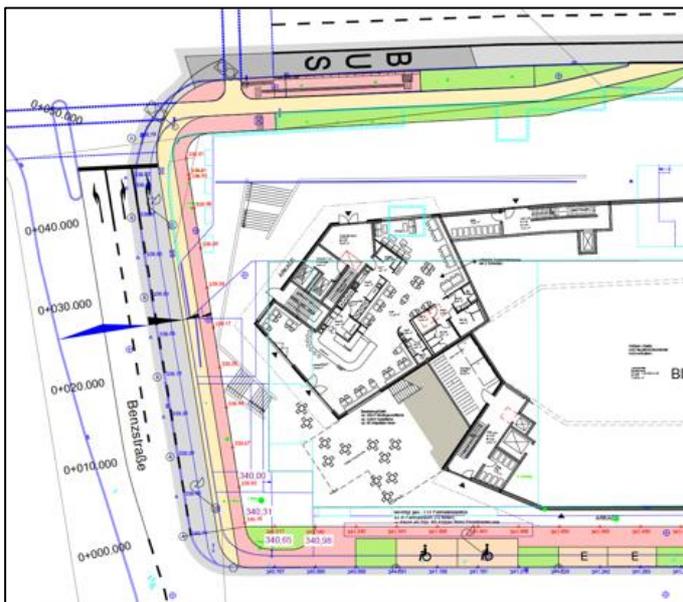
Vorentwurf Neugestaltung Grunewaldstraße und Benzstraße, Ing. Büro Altmann
